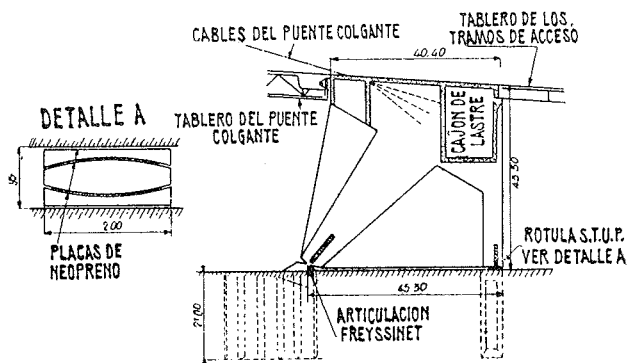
Empleo de rótulas de neopreno en el macizo izquierdo de anclaje.
